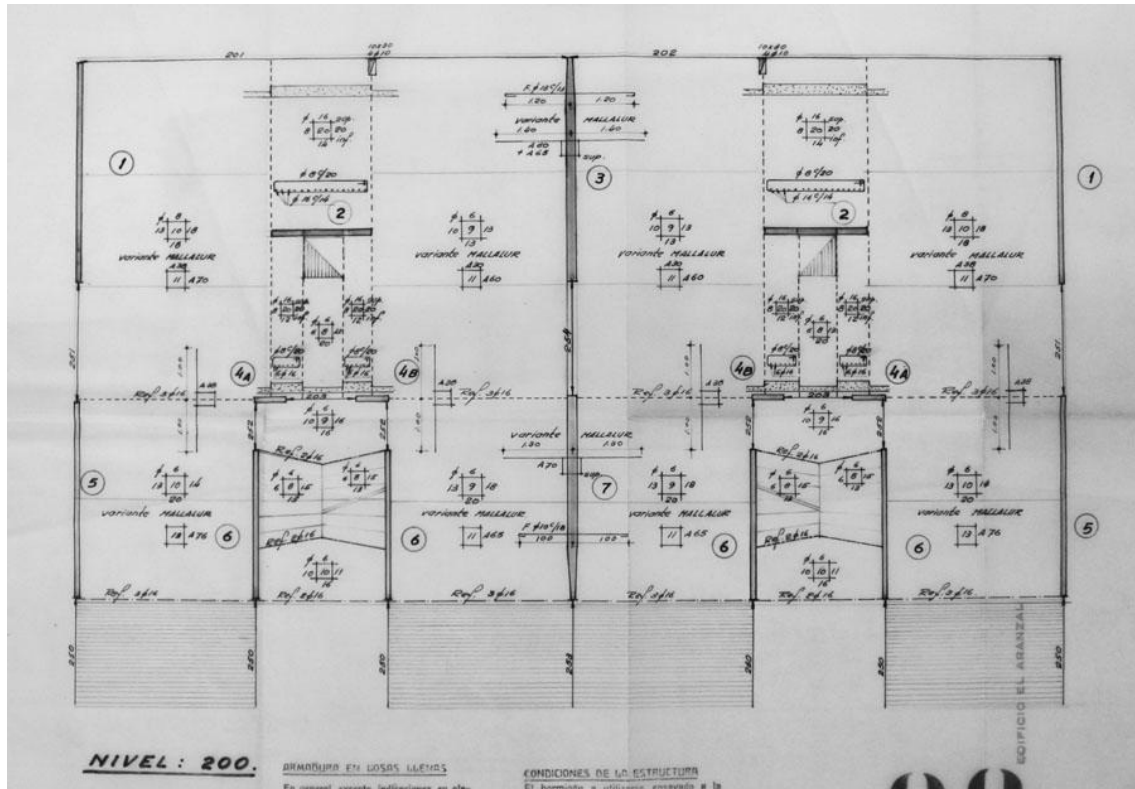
Planta Nivel 200 del edificio El Aranzal. Fuente: Centro de Documentación del Instituto de Historia, FADU, Udelar.
